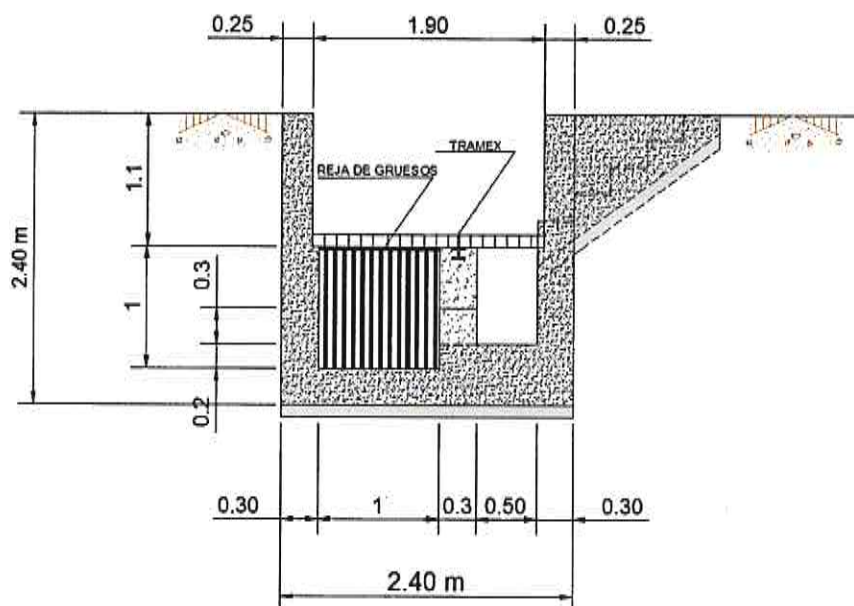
Alzado de la arqueta. Fuente: Elaboración propia
